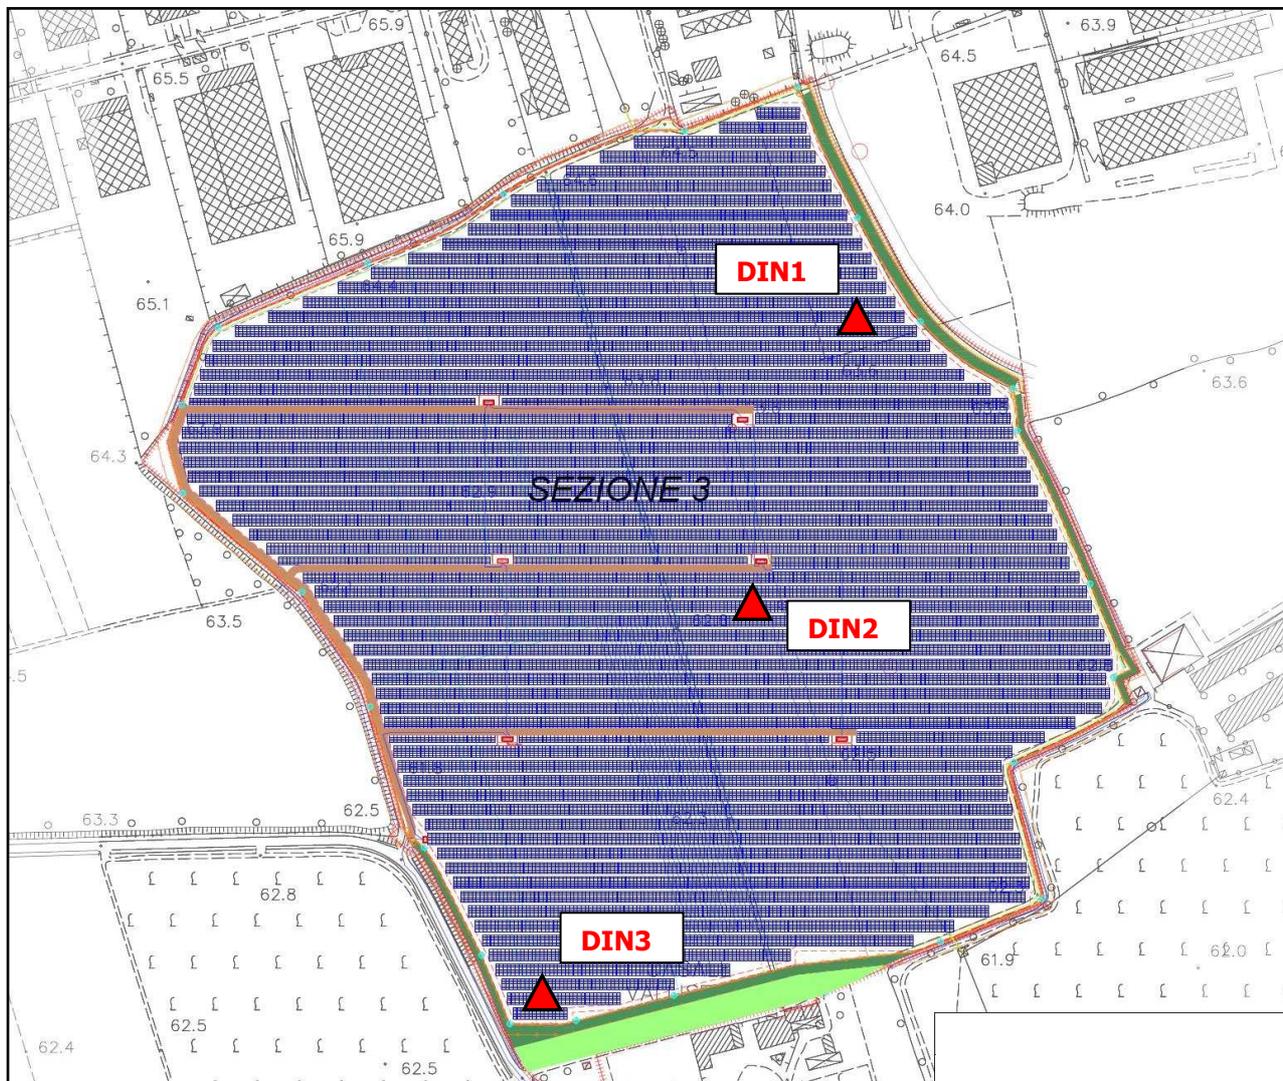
Planimetria Sezione 3 (Non in Scala).
